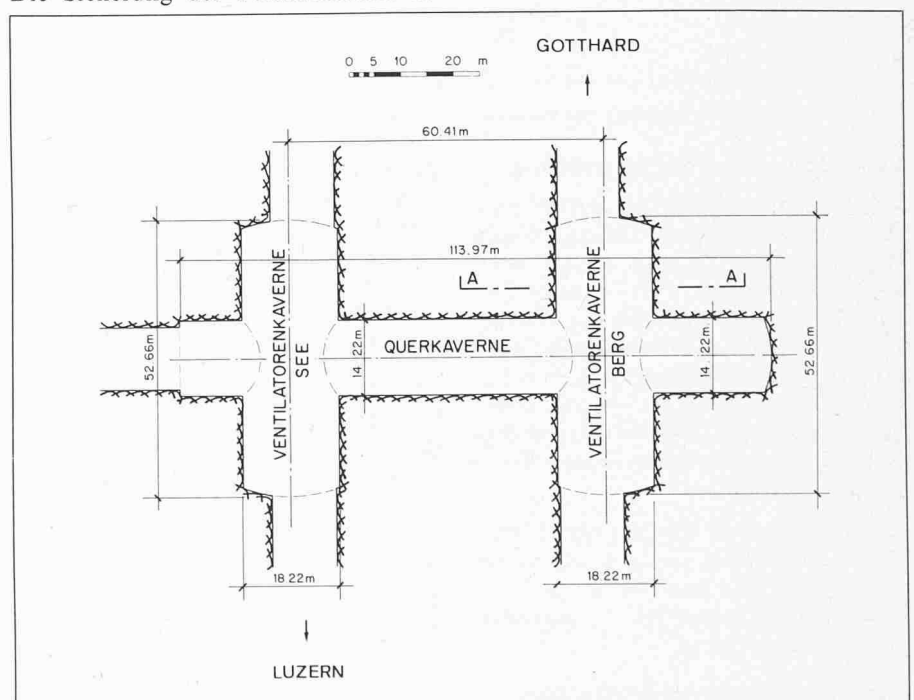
Lüftungszentrale Huttegg. Grundriss (Schnitte vgl. Bild 3)
